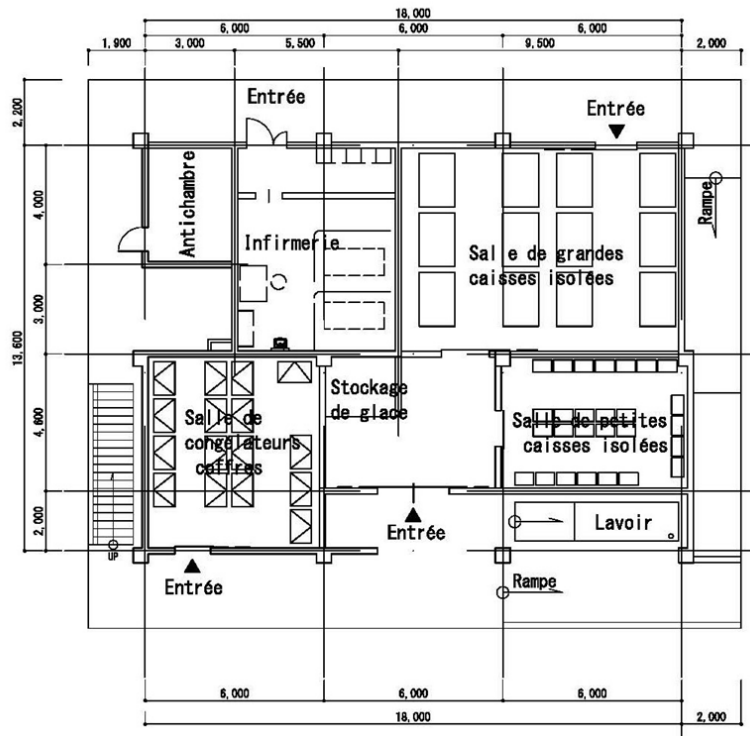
Plan du rez-de-chaussée du bâtiment de stockage des produits halieutiques
